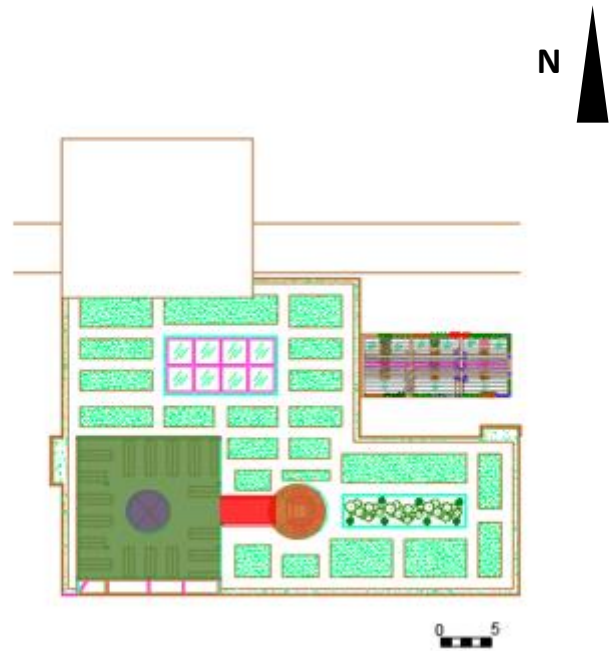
plan 3^{ème} jusqu'au 6^{ème} étage
